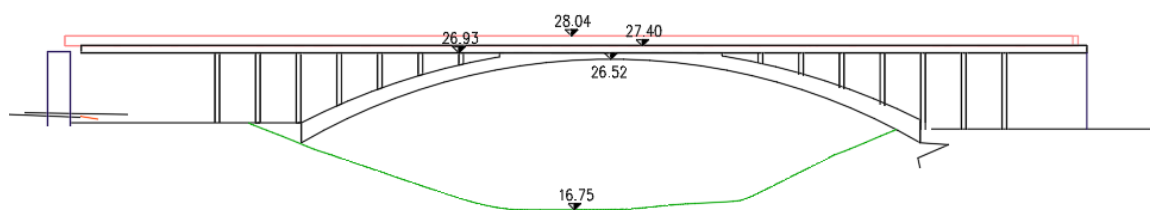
Prospetto dell’attraversamento sul fiume Aniene del GRA.
